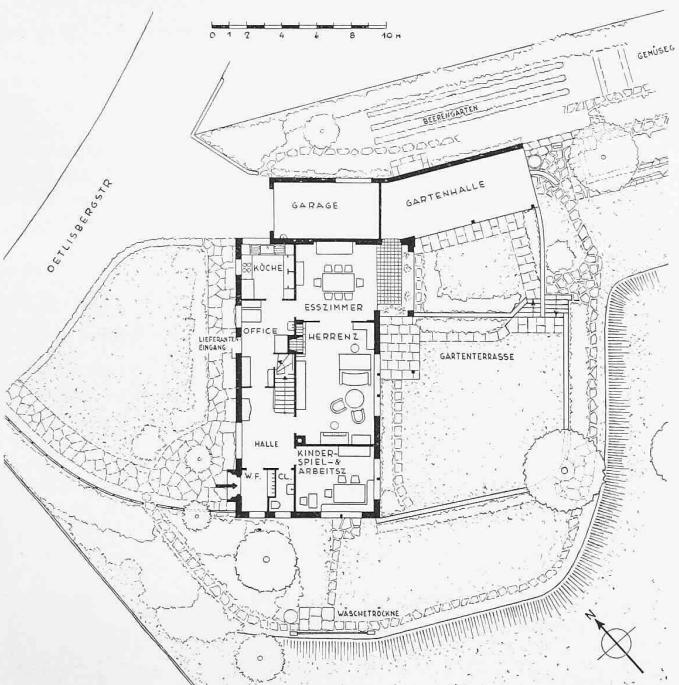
Grundriss und Gartenplan 1:400 zum Hause Dir. v. B.
